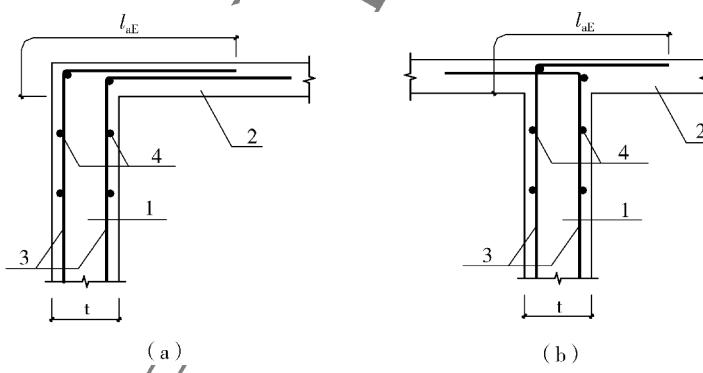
顶层节点区墙纵向钢筋锚固大样
